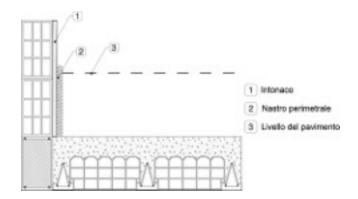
Particolare: nastro isolante perimetrale rispetto al livello del pavimento finito
